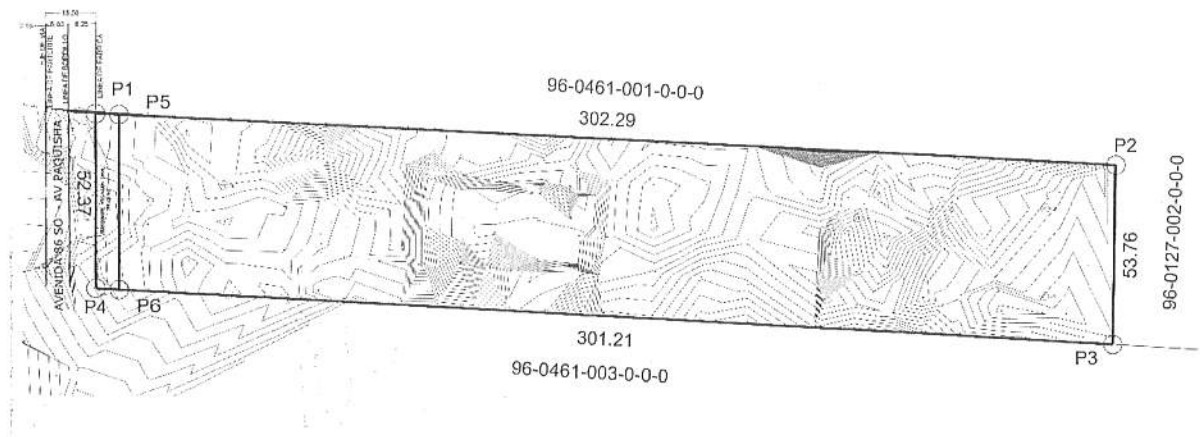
Plano Topográfico Altimetría y Planimetría del Proyecto Mirabella
